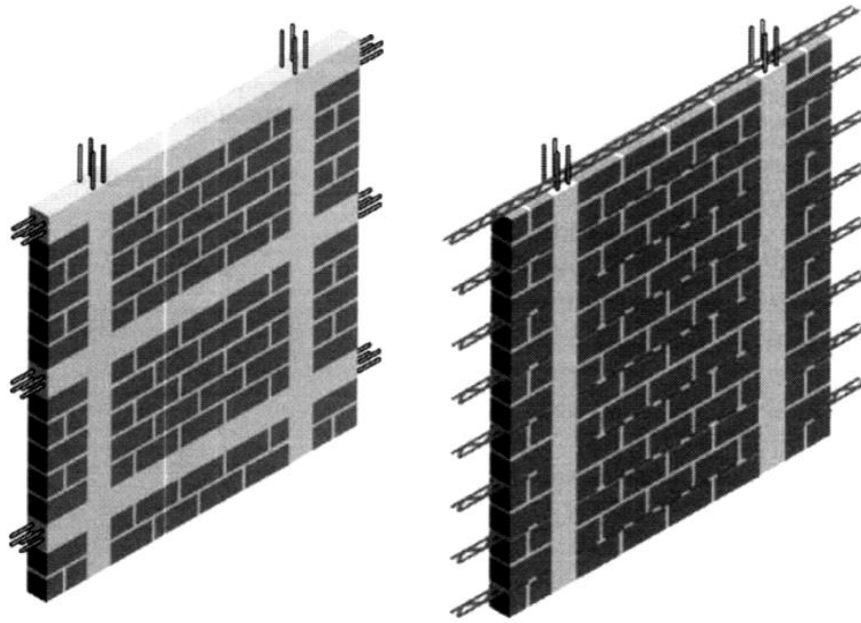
Вертикальное и горизонтальное армирование каменной стены железобетонным каркасом при сейсмических воздействиях [21]
